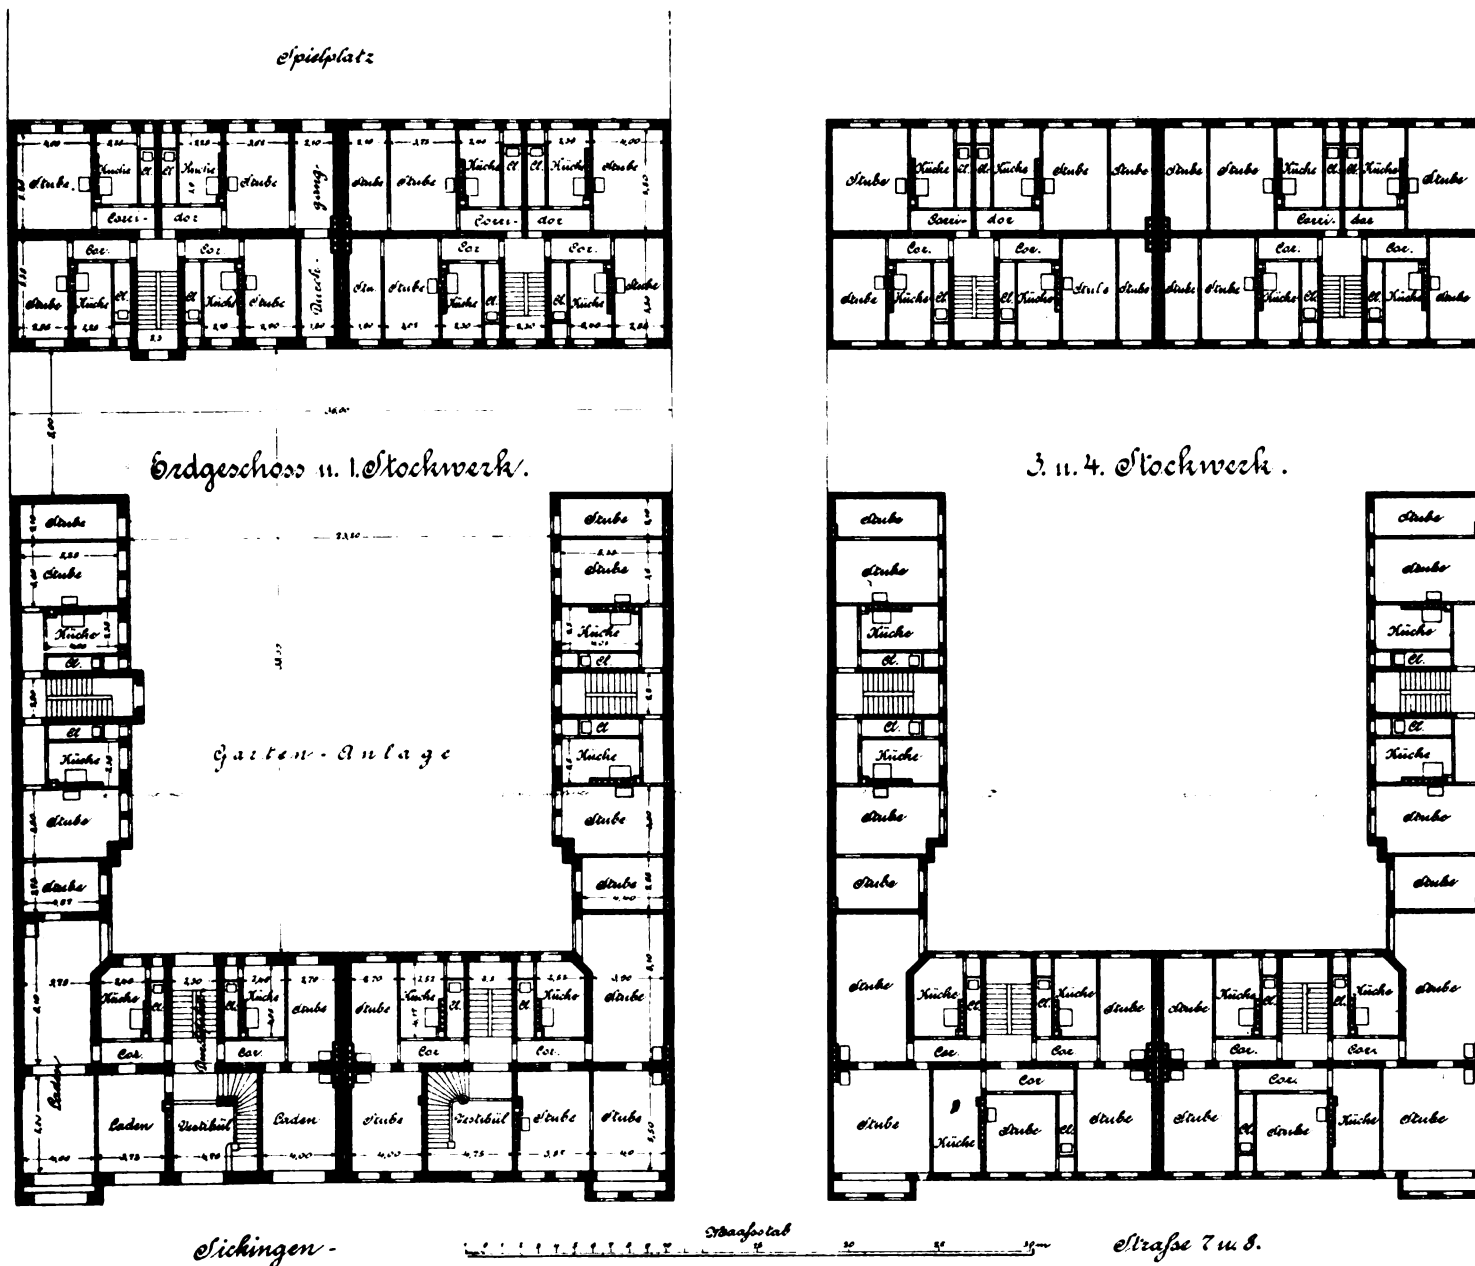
Grundrisse des Hauses an der Sickingenstraße.
